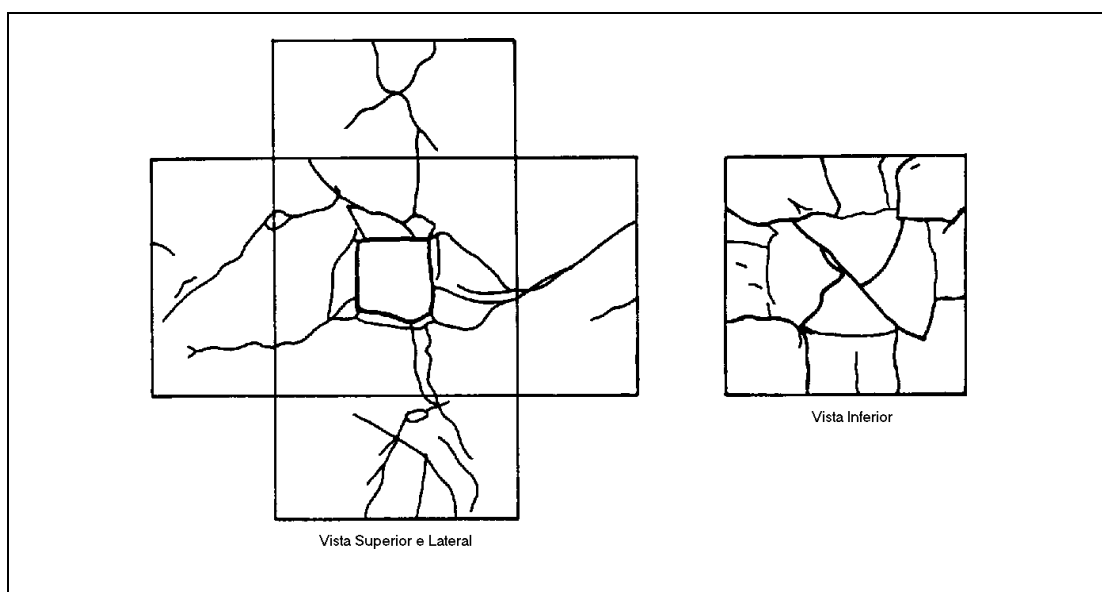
Panorama de fissuração experimental obtido por Sam; Iyer (1995) para bloco rígido de fundação com armadura concentrada sobre as estacas
